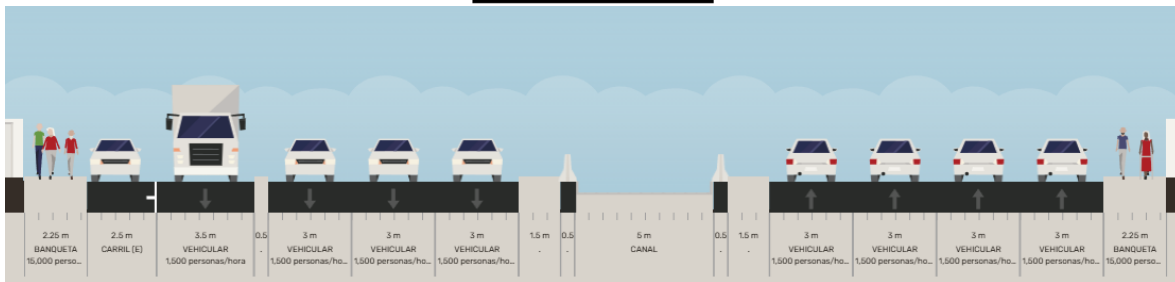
Sección vial de Av. Desarrollo. Fuente: PDU2040
